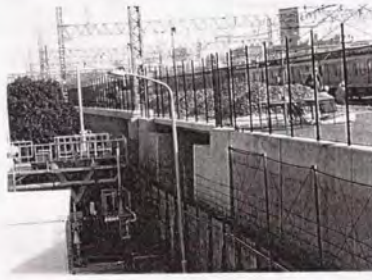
橋台部完成状況 (橋台No. 4)
